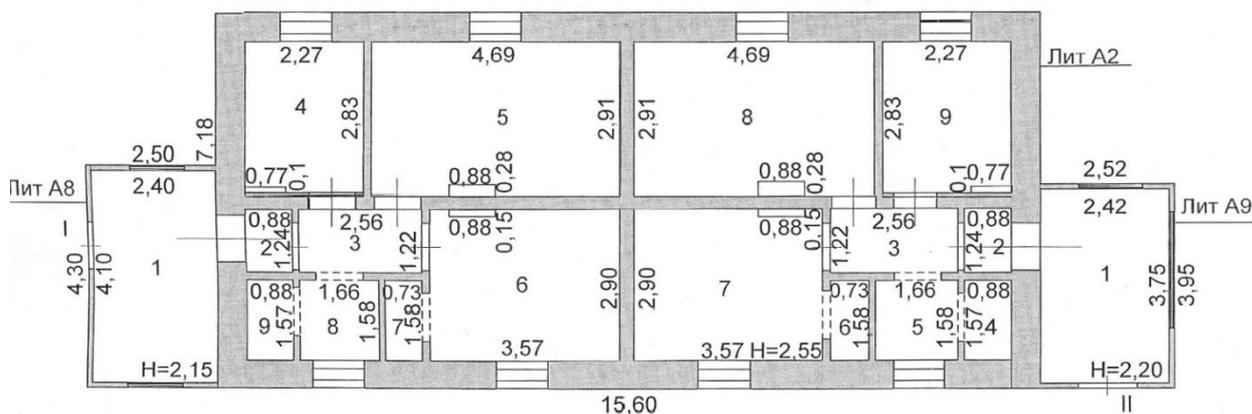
Поэтажный план жилого дома, площадью 97,5 кв.м
